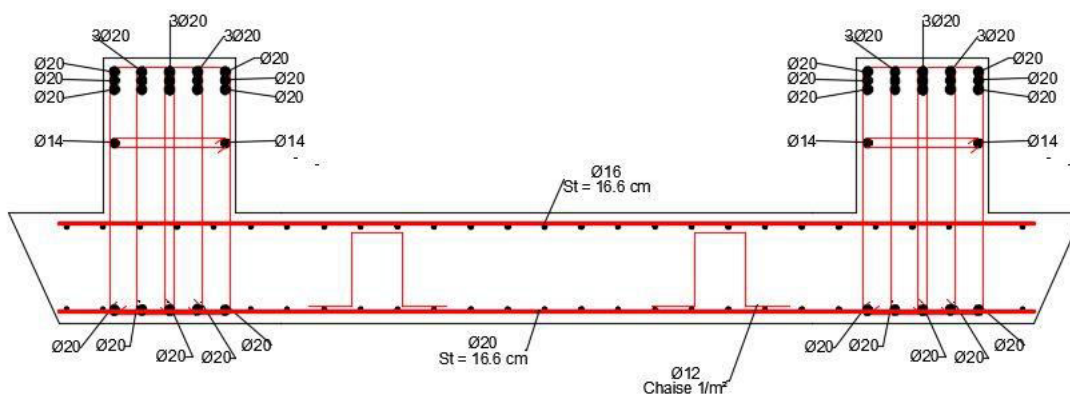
Vue en plan du ferrailage du radier dans le sens X-X
